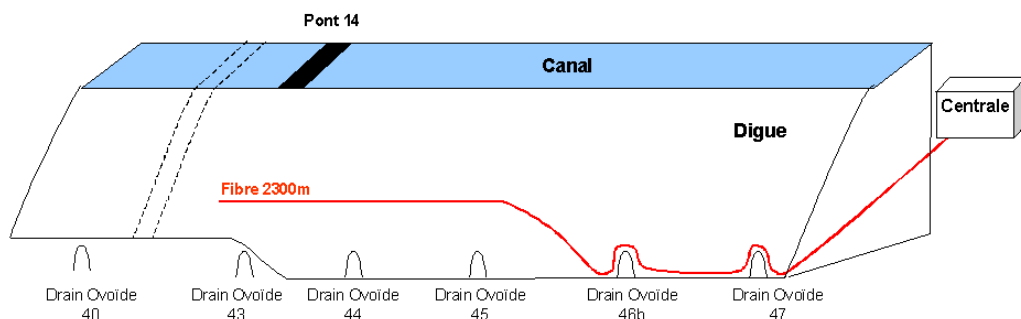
Installation d'une fibre optique sur le canal d'Oraison (coupe)
